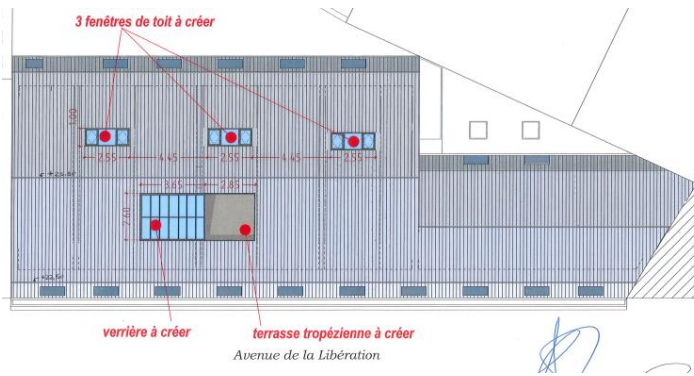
extrait d'un permis de construire : projet de création d'une terrasse de toit ainsi que des fenêtres de toit
